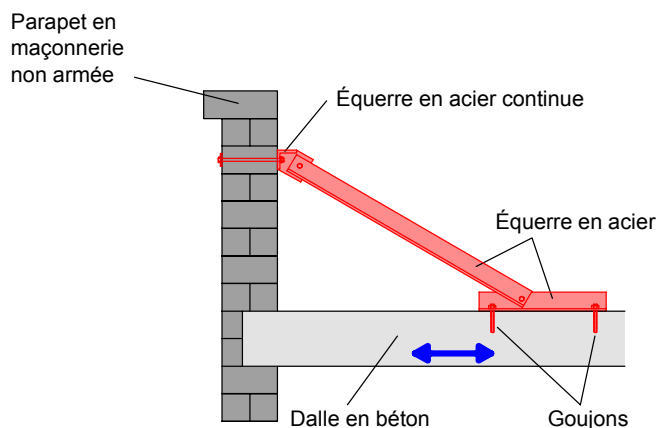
> Mesures applicables aux parapets sur toiture
